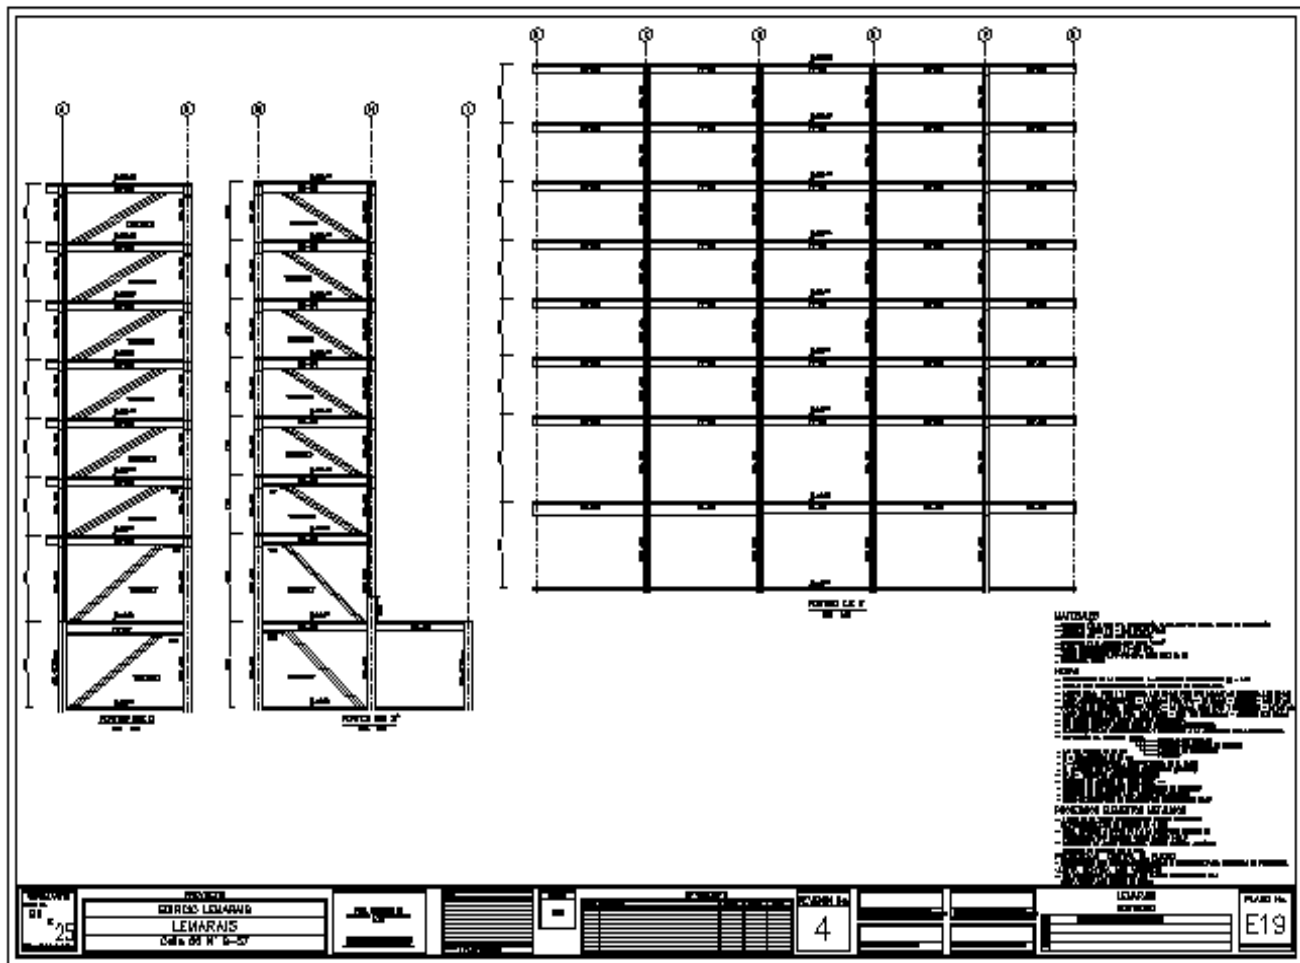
PLANO ESTRUCTURAL – ALZADOS PORTICOS Y DETALLES EJES 1.
